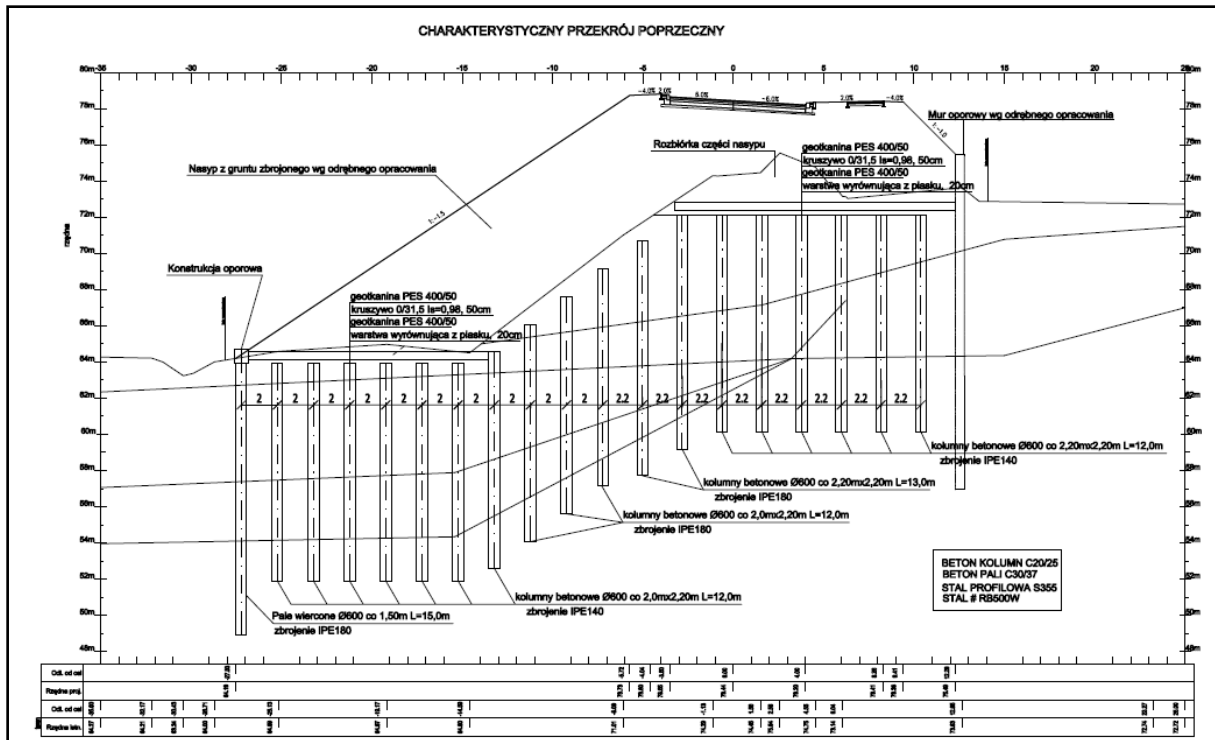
Plan wzmocnienia podłoża gruntowego kolumnami, wg (34).
